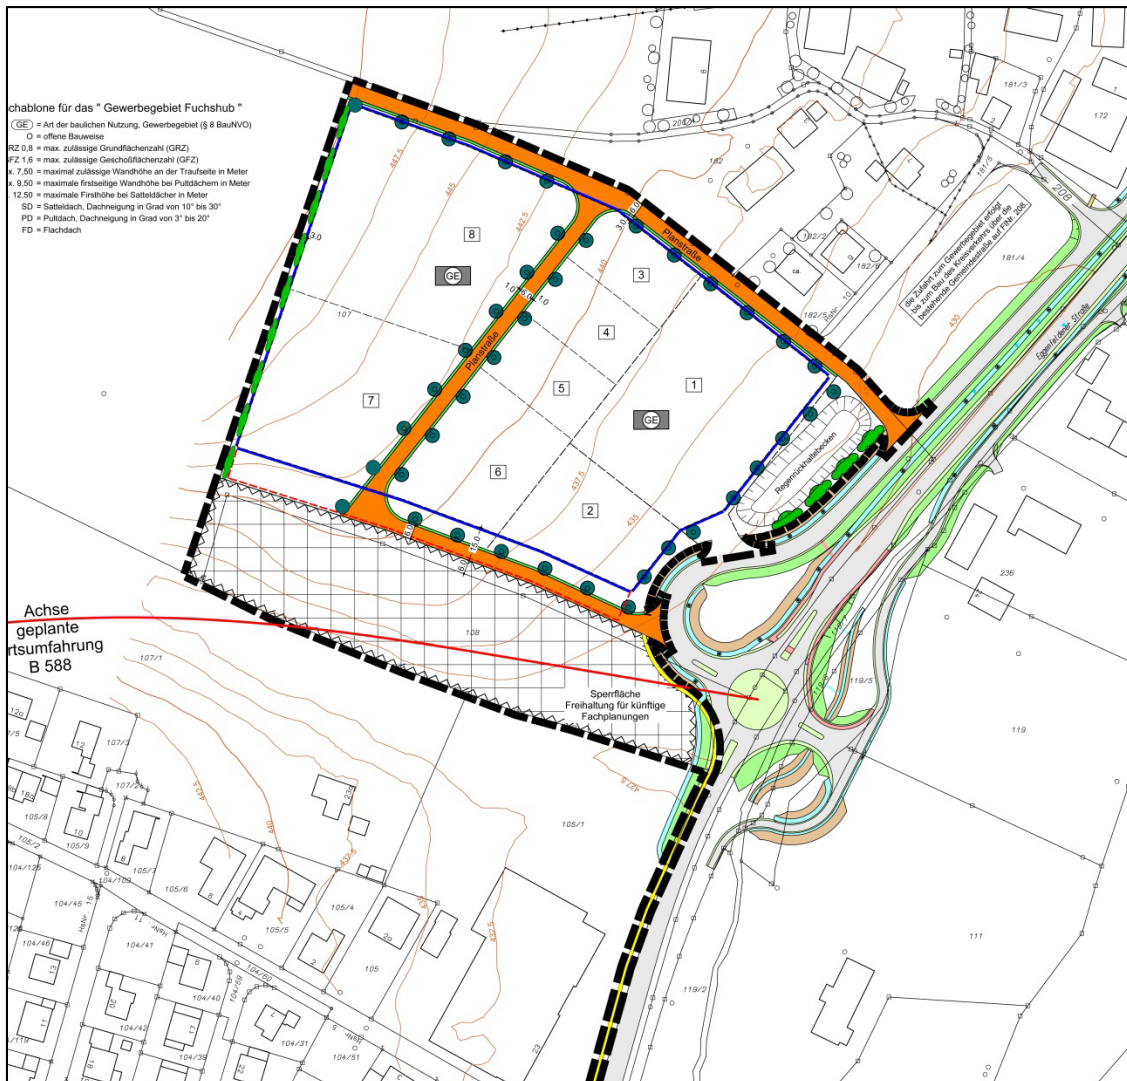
Planzeichnung zum Bebauungsplan Nr. 16 "Gewerbegebiet Fuchshub" /55/
